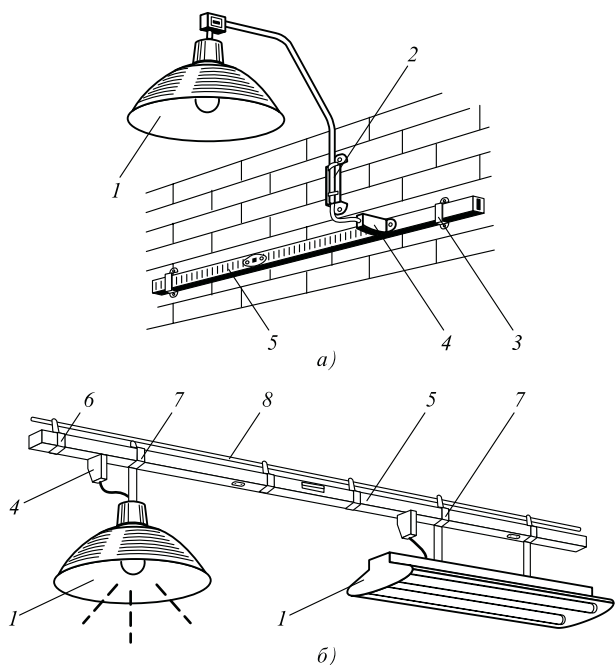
Крепление шинопровода ШОС-67 непосредственно на стене (а) и на предварительно натянутом тросе (б):
